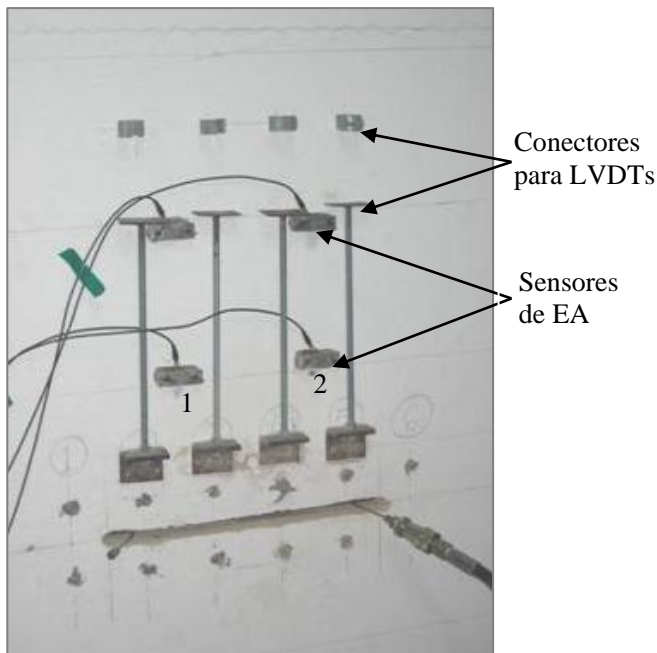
Disposição dos sensores acústicos durante o Ensaio A commacaco plano
